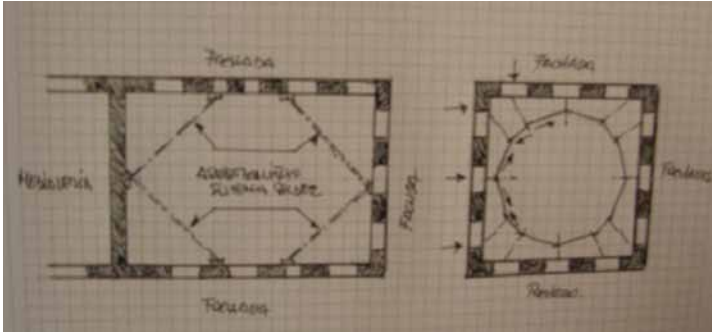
Planta de edificios con más de una fachada. Arriostramiento interior por plantas.
